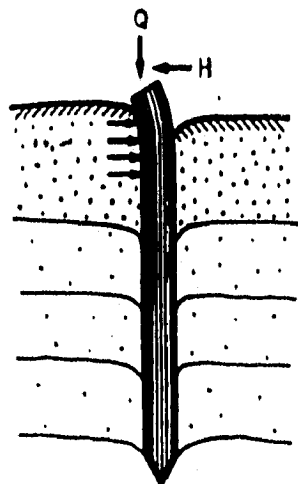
PILOTE CON CARGA HORIZONTAL
